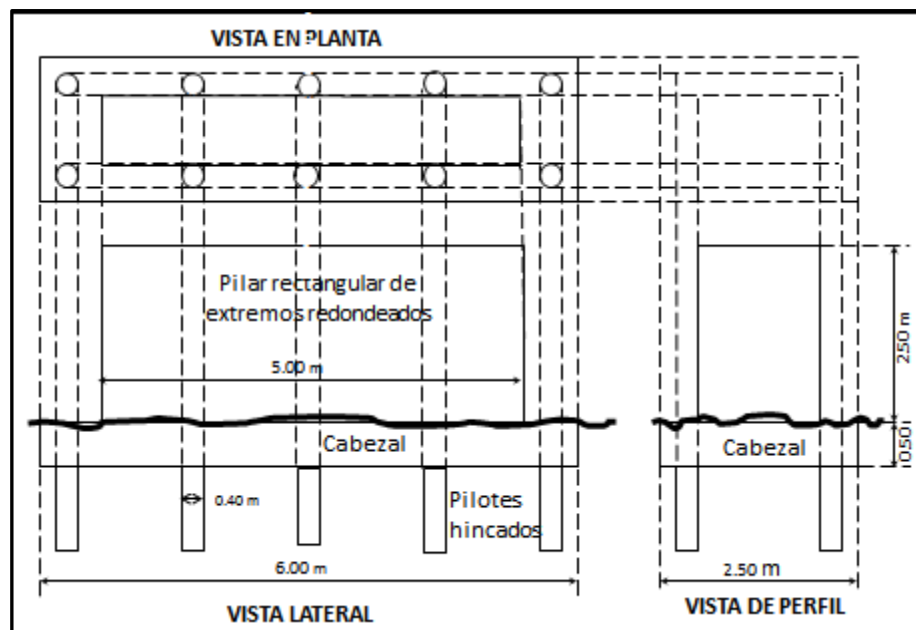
Croquis de uno de los sistemas de pilas de fundación del puente.
